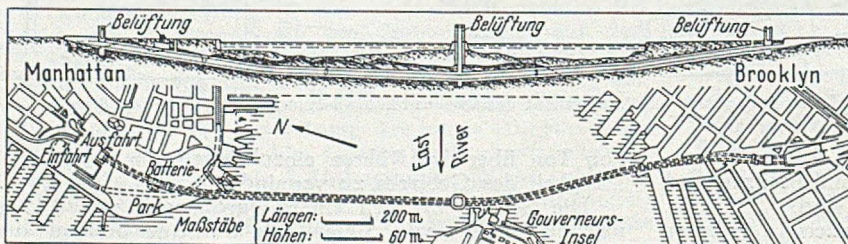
Lageplan und Längsschnitt des Brooklyn-Battery-Tunnels unter dem East-River.
